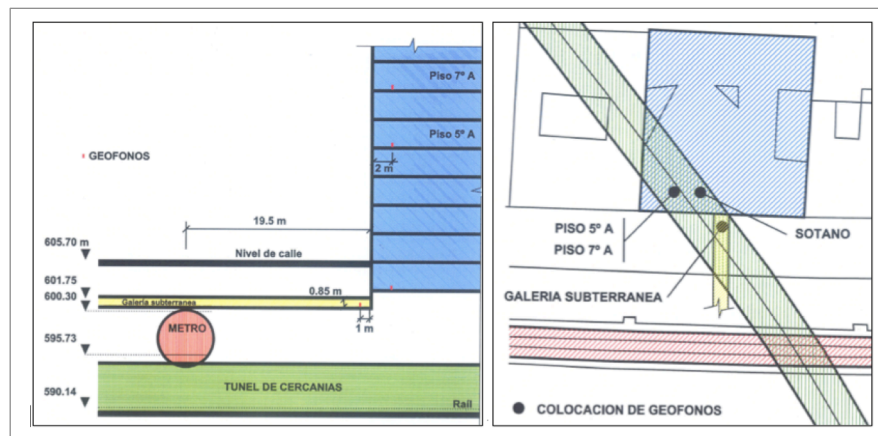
Representación esquemática del sistema túnel-edificio (sección transversal; esquema en planta)
